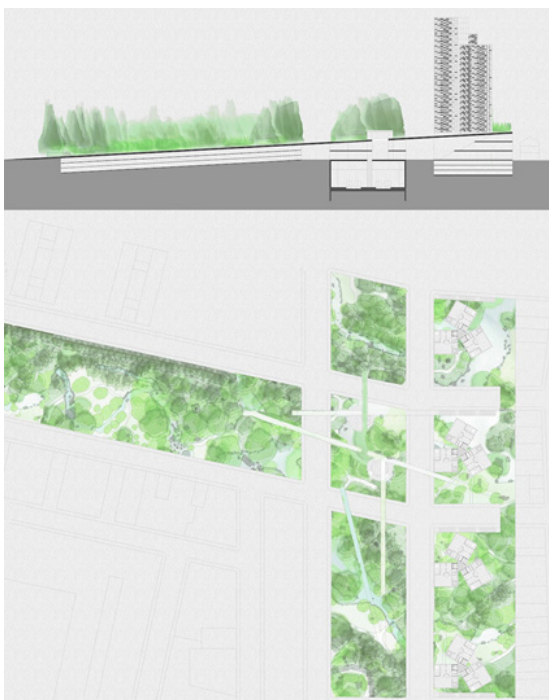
Planta y sección de la promenade final de Blasco Ibáñez.
